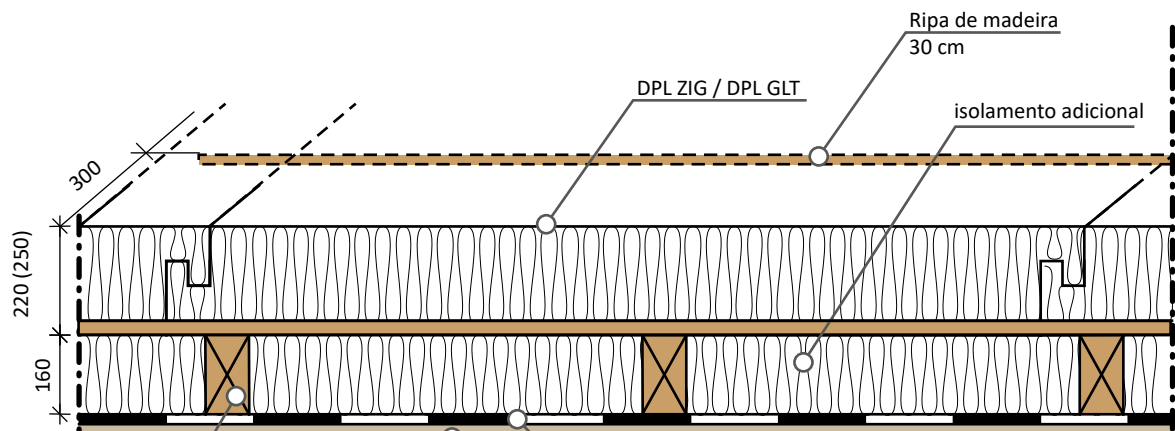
Imagem B. Seção horizontal de um teto inclinado feito com isolamento adicional entre as vigas.
